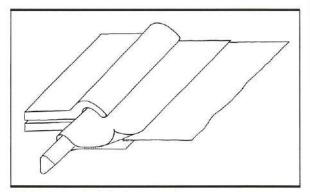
Detalle de borde con pasadores para membranas con cargas elevadas.
